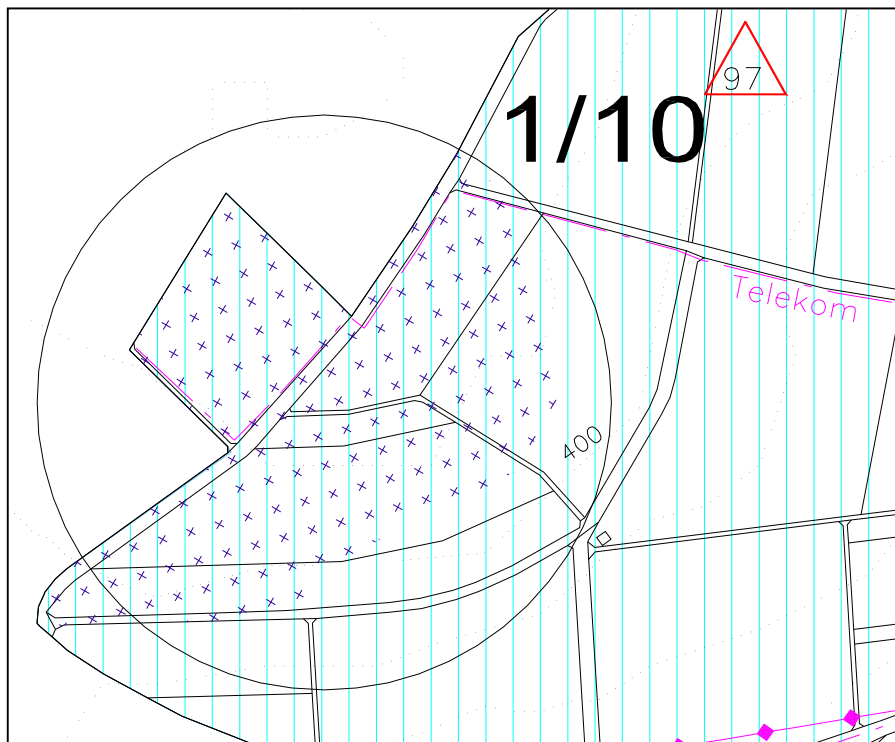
Änderungs-Nr. 1/10 (Niederrimbach)
